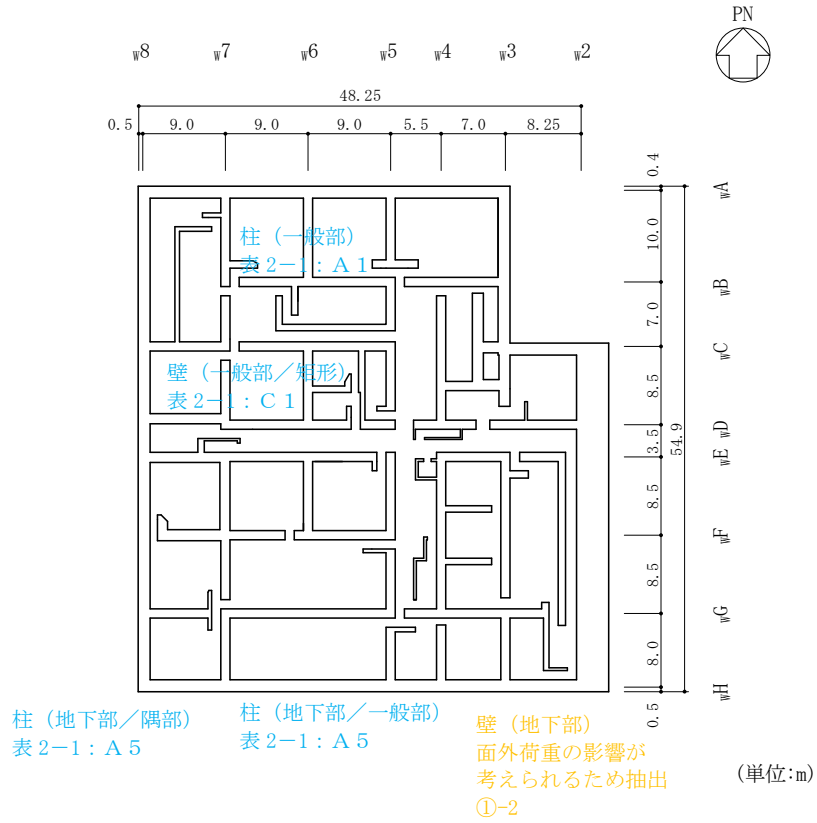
(1) 廃棄物処理建物の概略平面図 (EL 3.0m)
